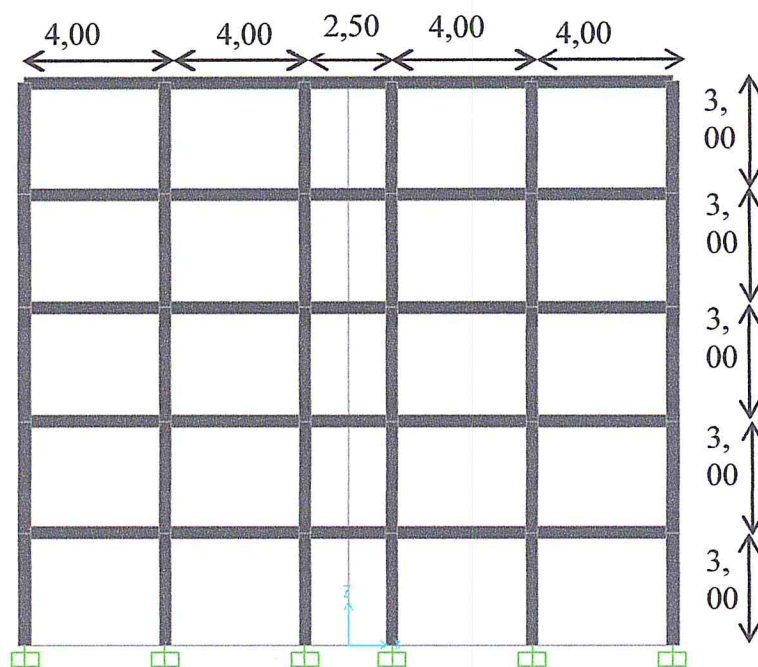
Vue en élévation du bâtiment en béton armé à 5 étages.
